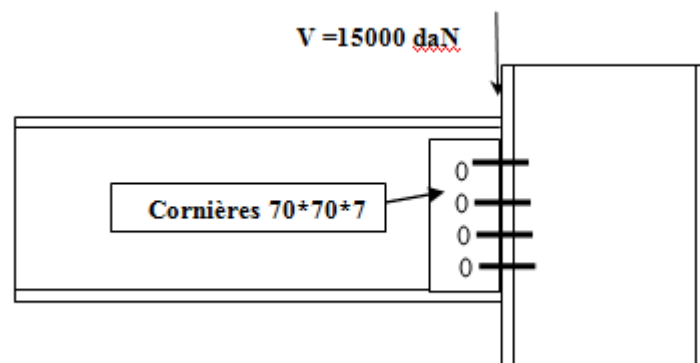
assemblage d'une poutre en IPE 300 avec un poteau en HEA 300.
